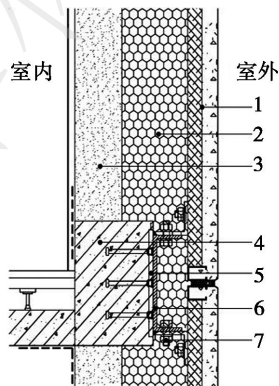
外叶墙板与建筑主体结构的连接构造 1
